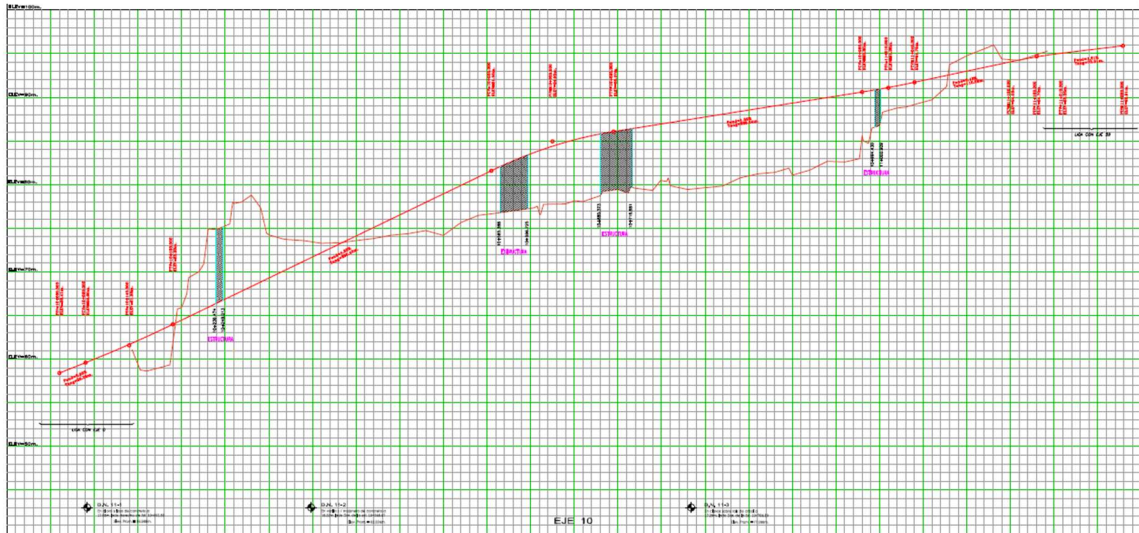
Perfil del Eje 10 con Estructuras y Ligas
